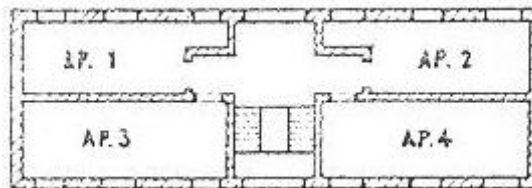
Lage des Treppenhauses im Bauwerk.
